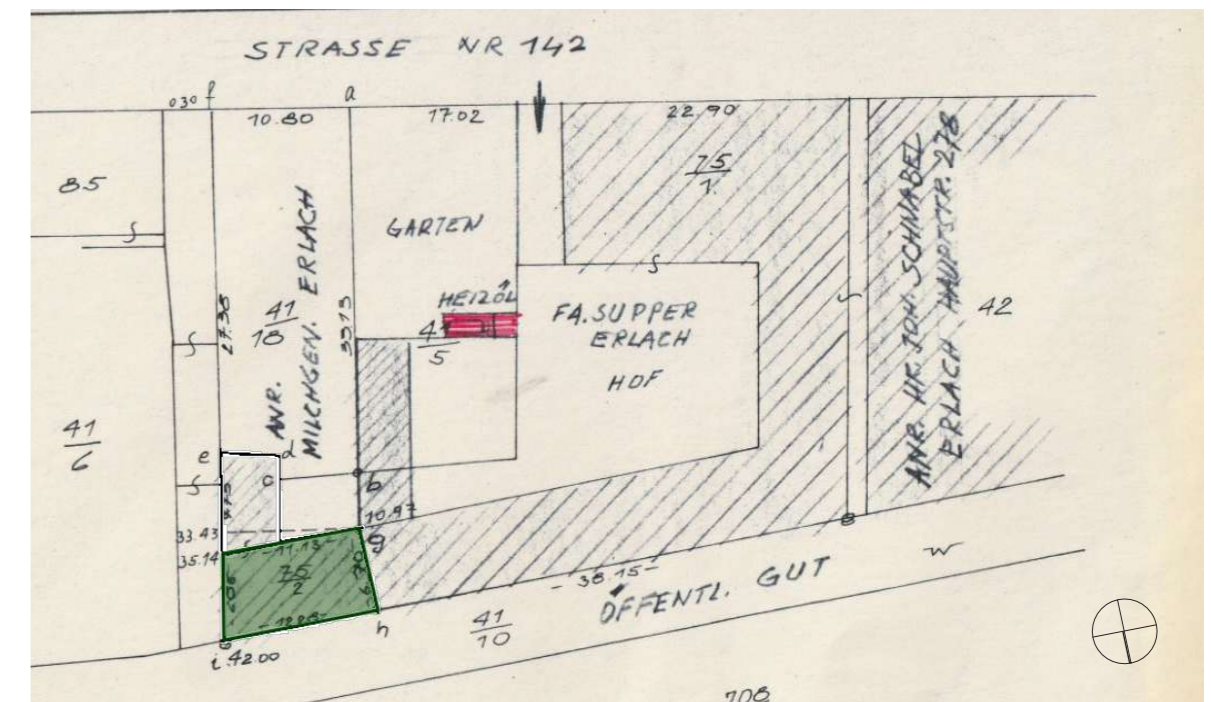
Lageplan des Grundstücks Erlach 69 mit grün markierter Synagoge (um 1960) [gbe]
